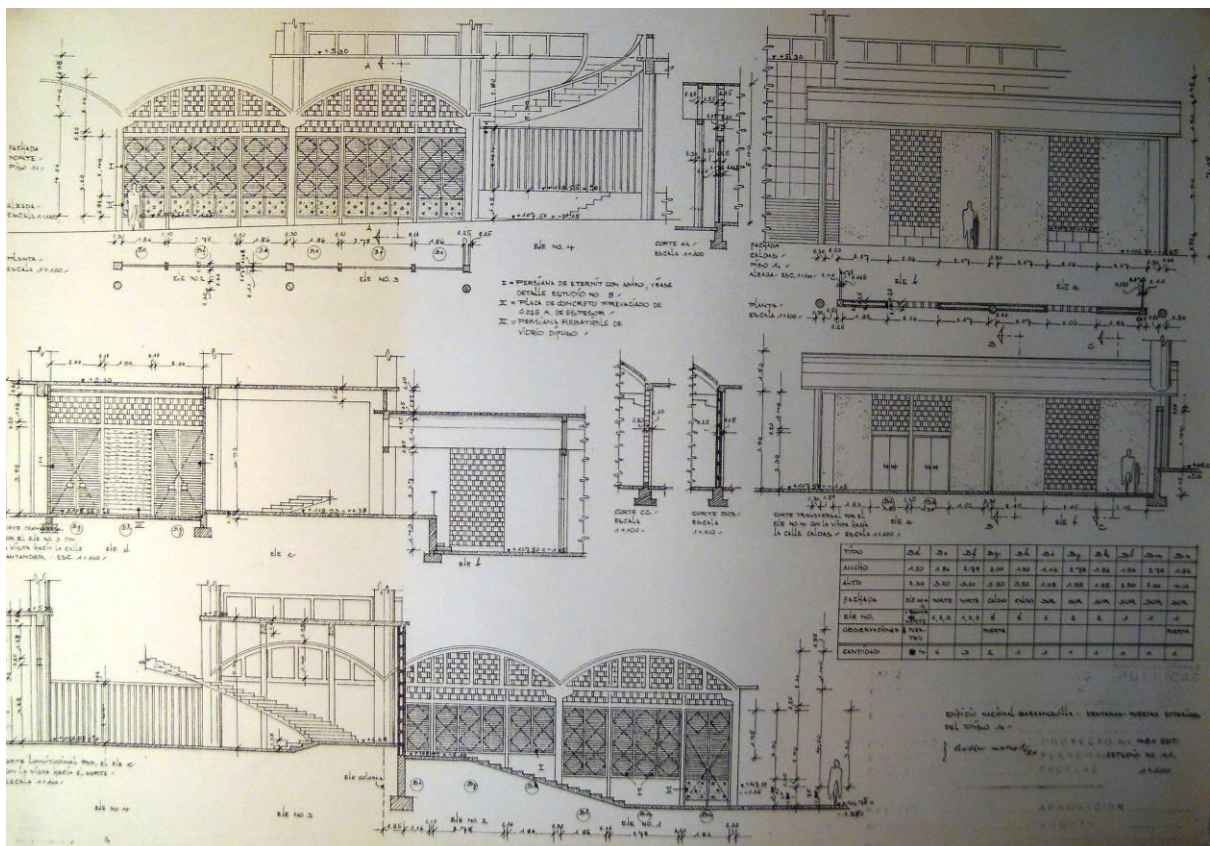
Baudetails der Betonschalen im Erdgeschoss.
